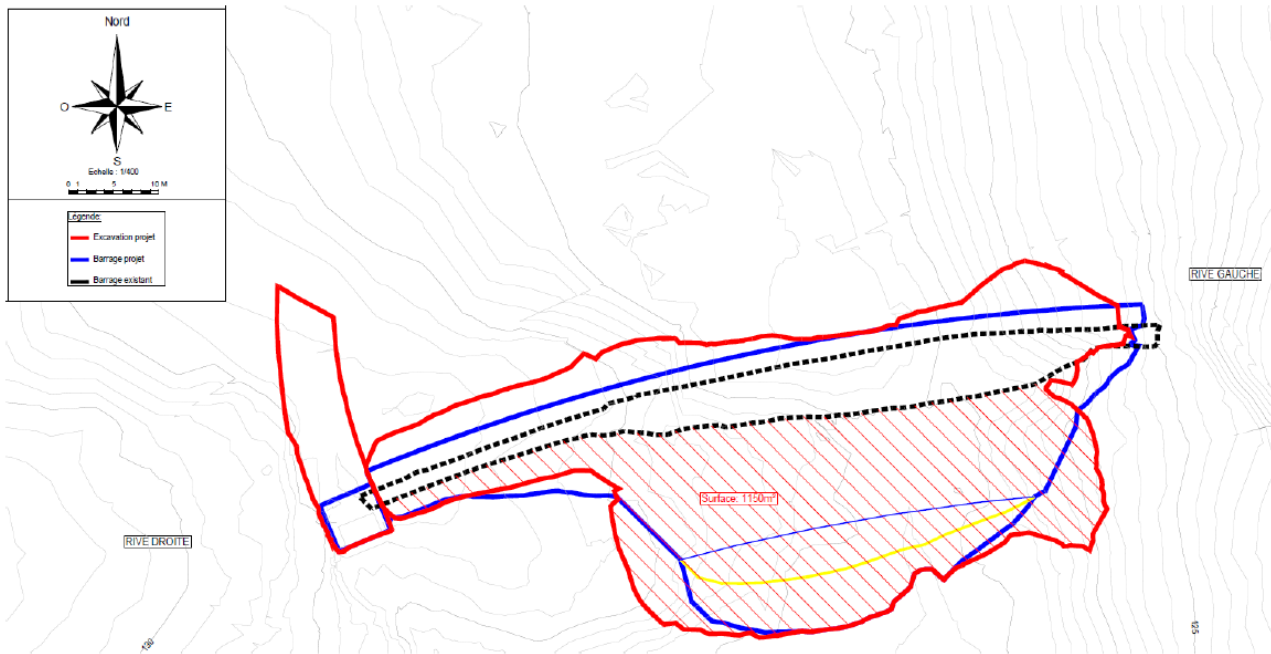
Emprise au sol du débroussaillage et décapage en vue de la reconstruction du barrage:
